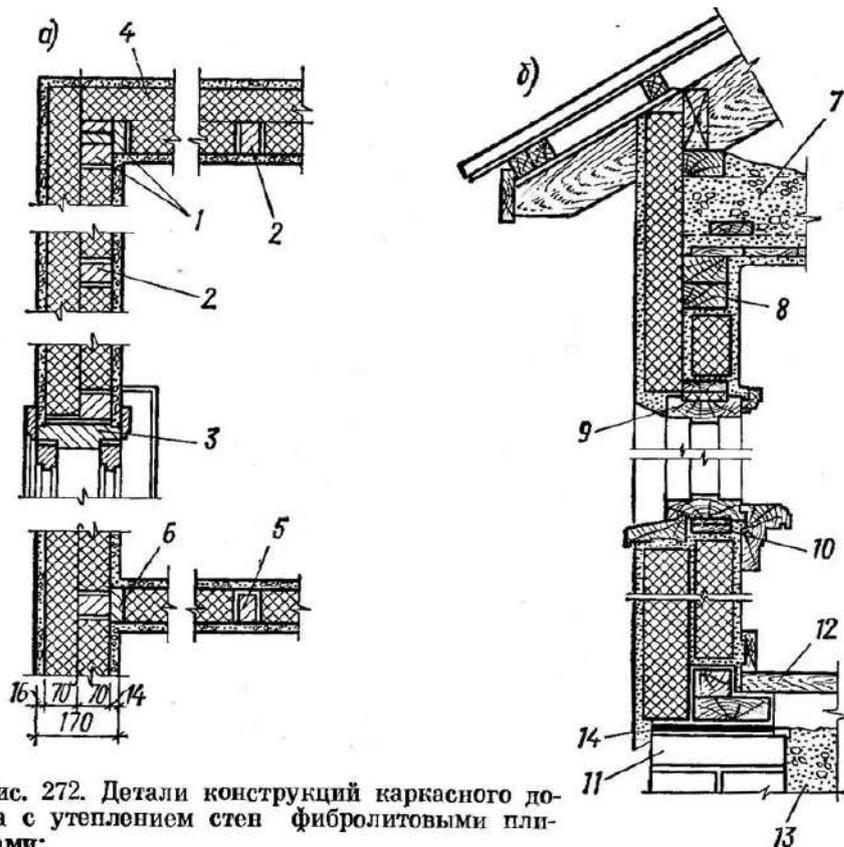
Детали конструкций каркасного дома с утеплением стен фибролитовыми плитами:
